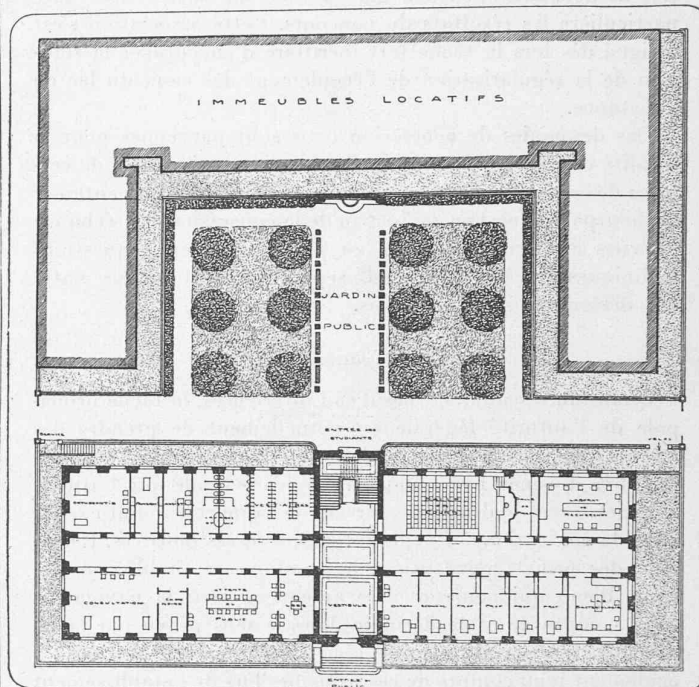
Plan du rez-de-chaussée. — 1 : 800.
